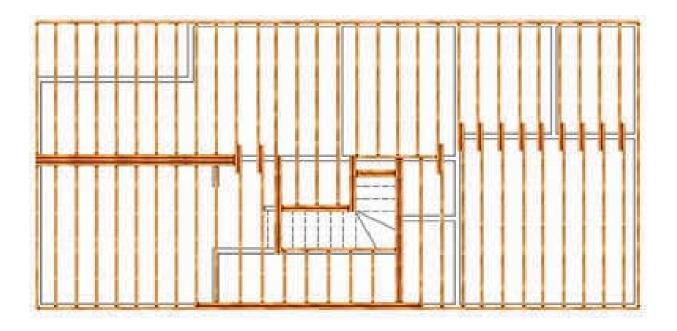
19: Etapa 2, montaje vigas secundarias en la estructura de entrepiso.
